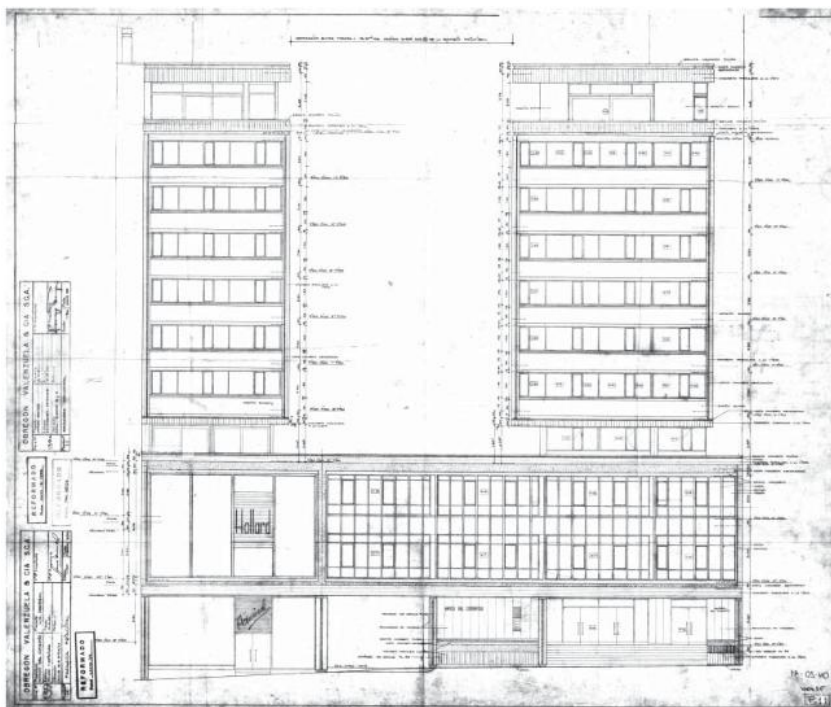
, Banco del Comercio y Edificio de renta Jorge Rojas, fachada frontal. Planoteca Obregón & Valenzuela, Archivo Distrital de Bogotá.
